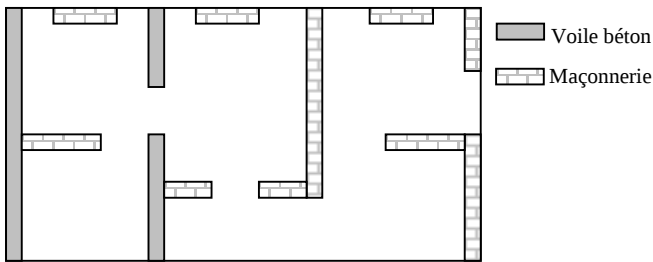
Vue en plan. Éléments de contreventement de natures différentes.
